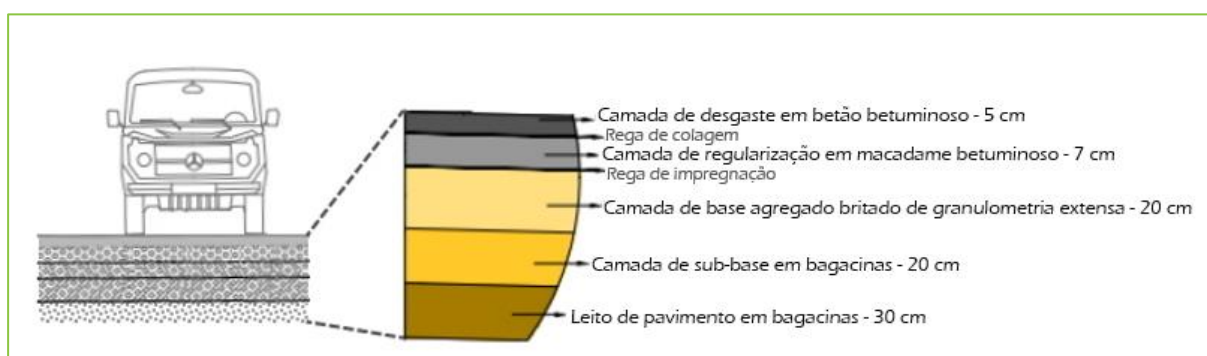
| Representação esquemática da estrutura do pavimento (adaptado do projeto)
